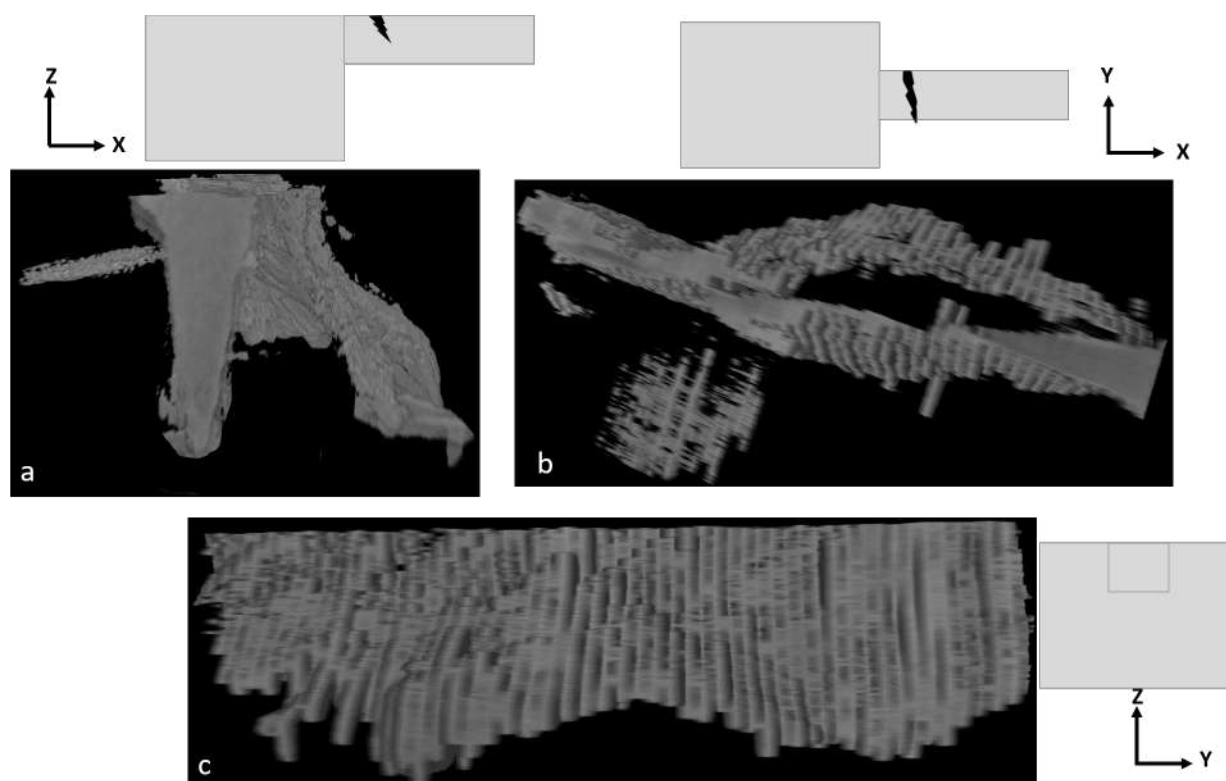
Reconstruction 3D du volume fissuré pour la Poutre4-ox7470h. a) vue de face b) vue du dessus et c) vue de côté
